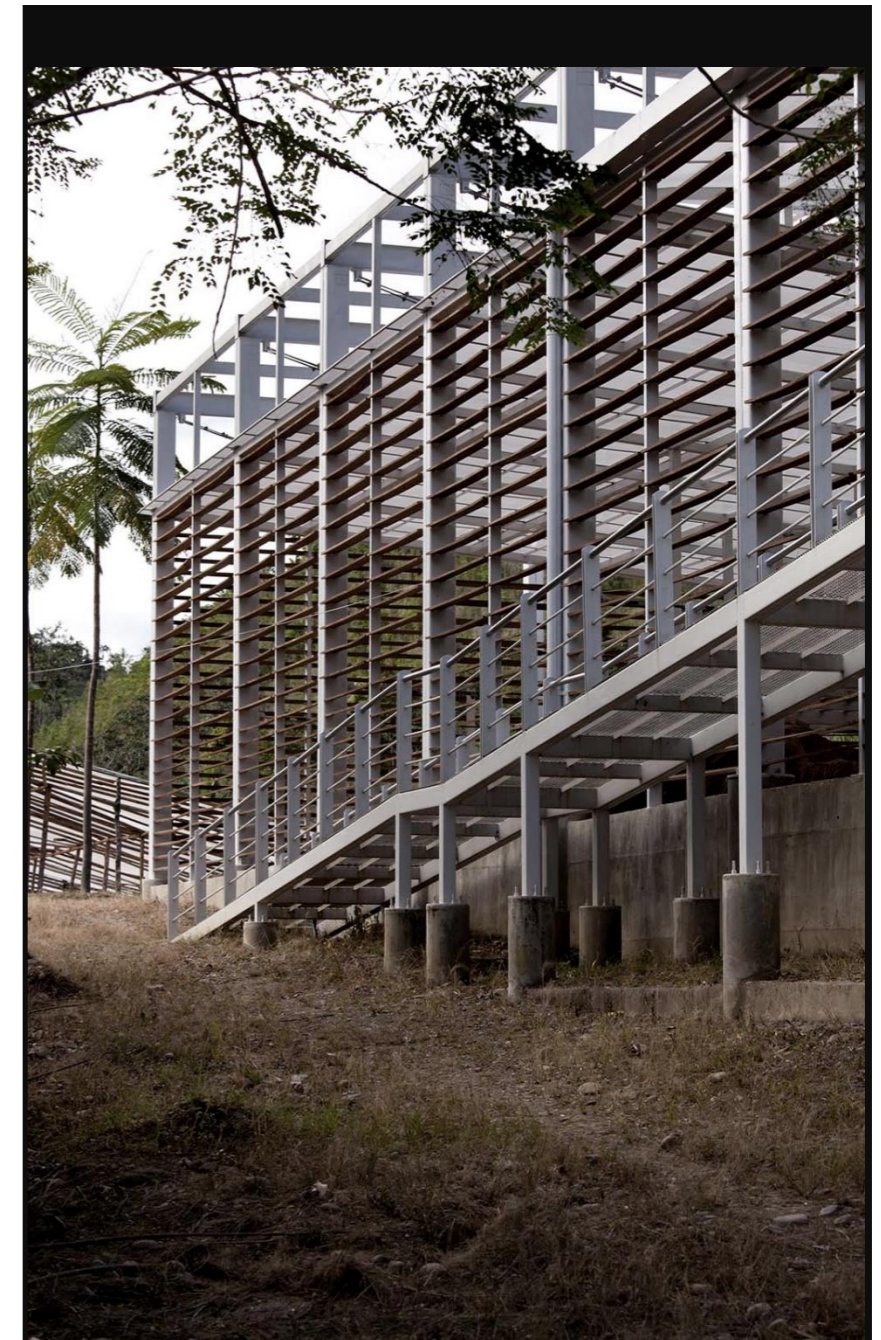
Vista exterior cubierta en Santa Ana- Florida
